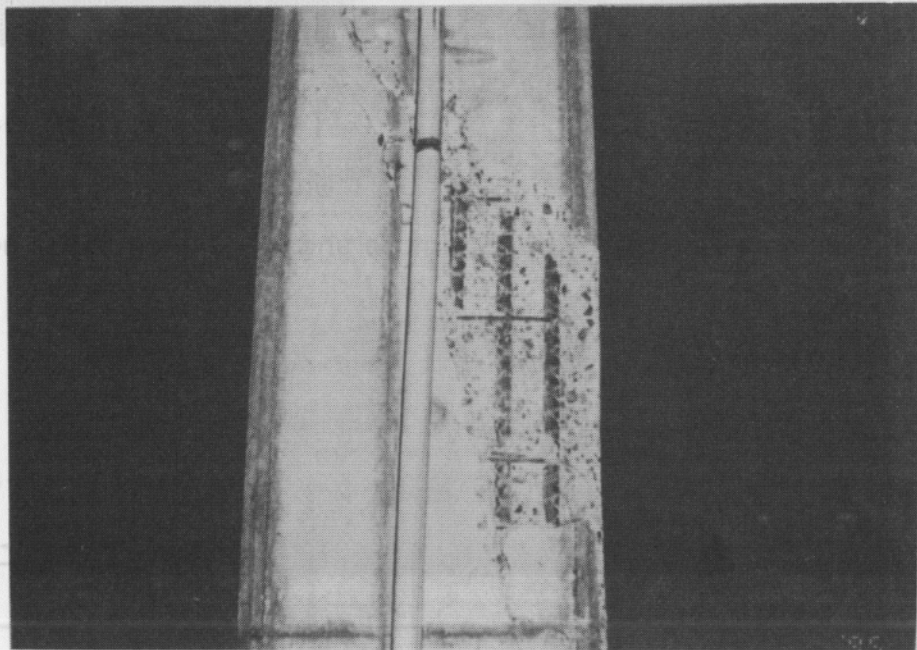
上沢駅B2階 中柱でのかぶりコンクリートの剥落
